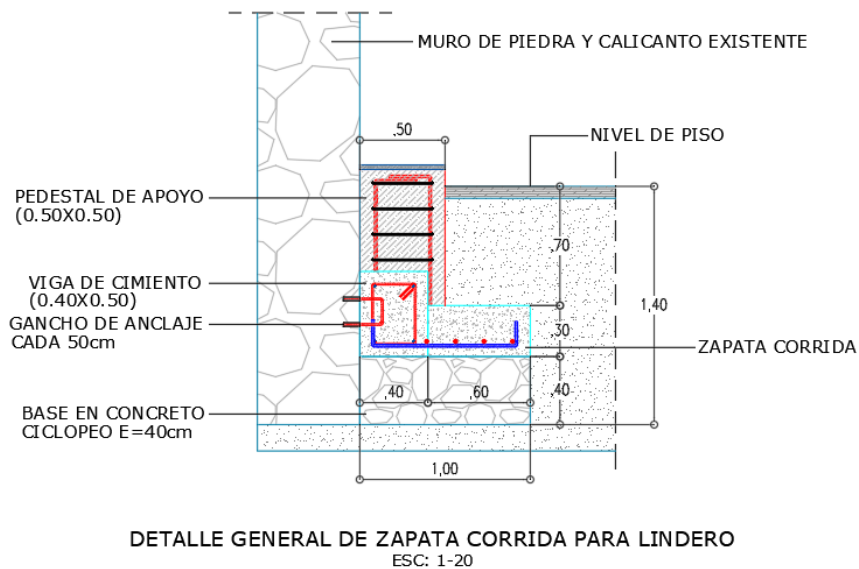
Detalle de sistema de cimentacion. Fuente. Ing. Alvaro Caballero
